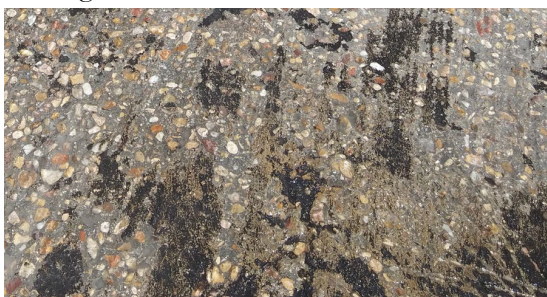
Película bituminosa adherida a la superficie de hormigón existente.
